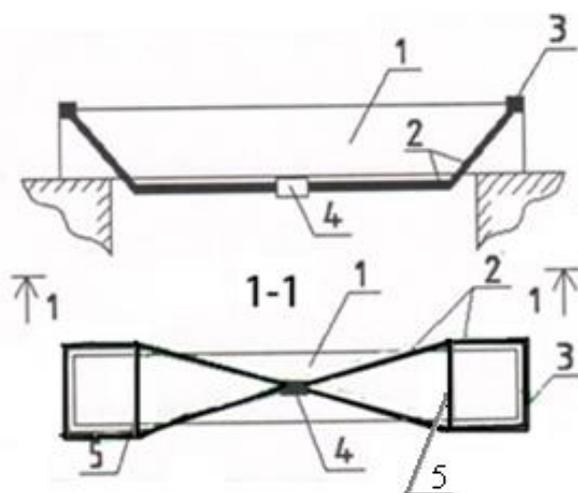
Схема усиления железобетонной балки шпренгельной затяжкой:
